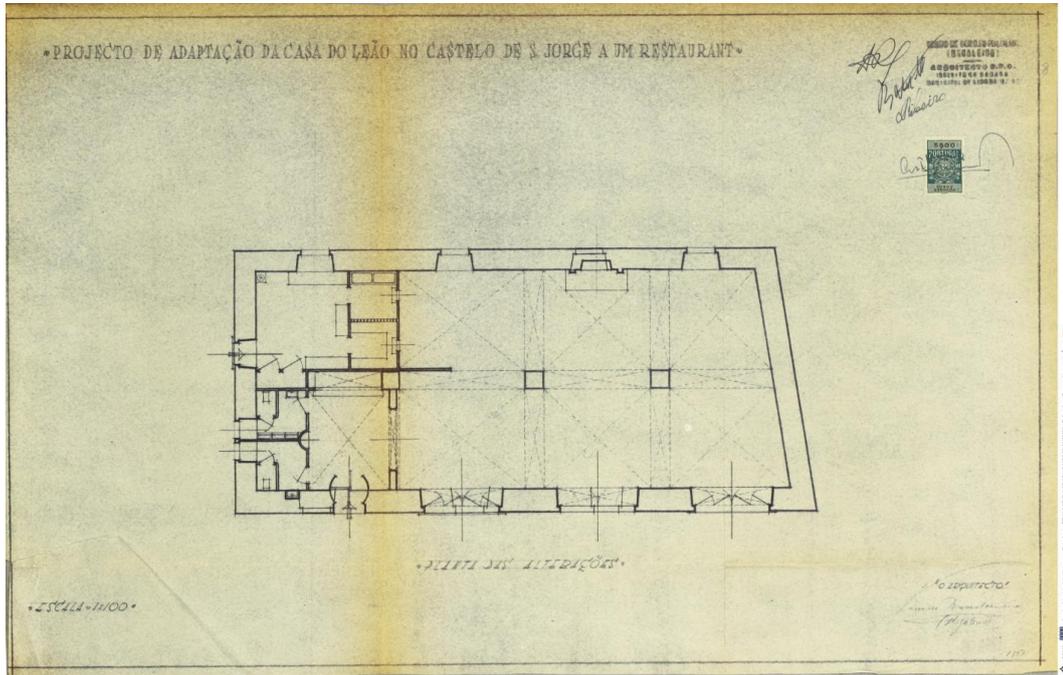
Projecto de adaptação da Casa do Leão a restaurante – Planta de alterações (AML).
